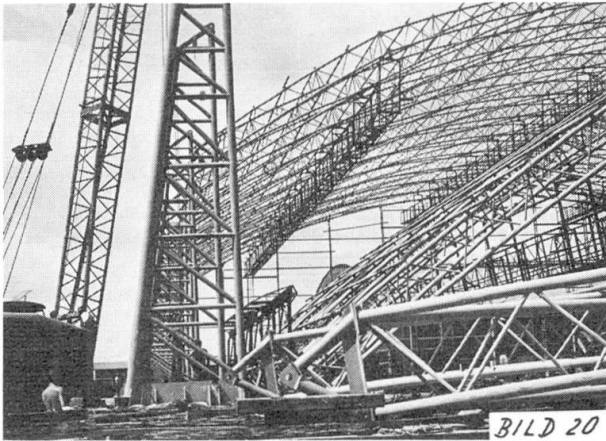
zeigt den Ausbau der Halle Berlin III, dessen Querschnitt bereits im Bilde 10 gezeigt wurde.
